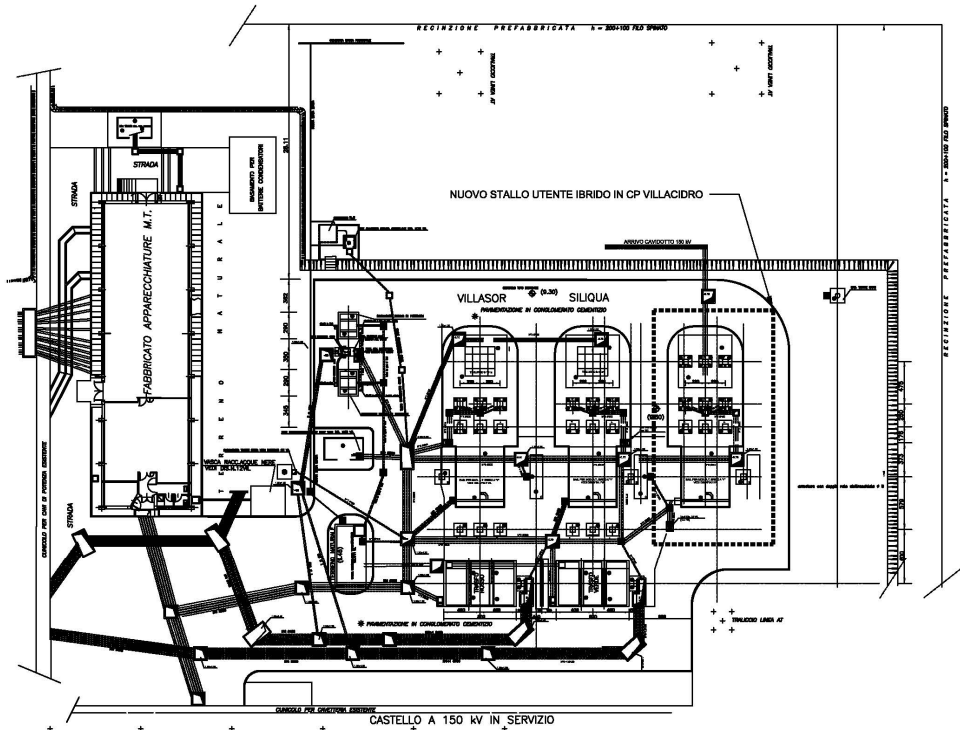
PLANIMETRIA NUOVO STALLO IBRIDO
